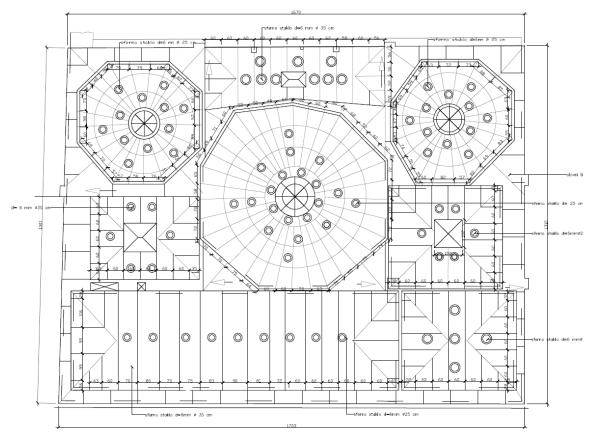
Čejvan – Ćehajin Hammam – roof plan
